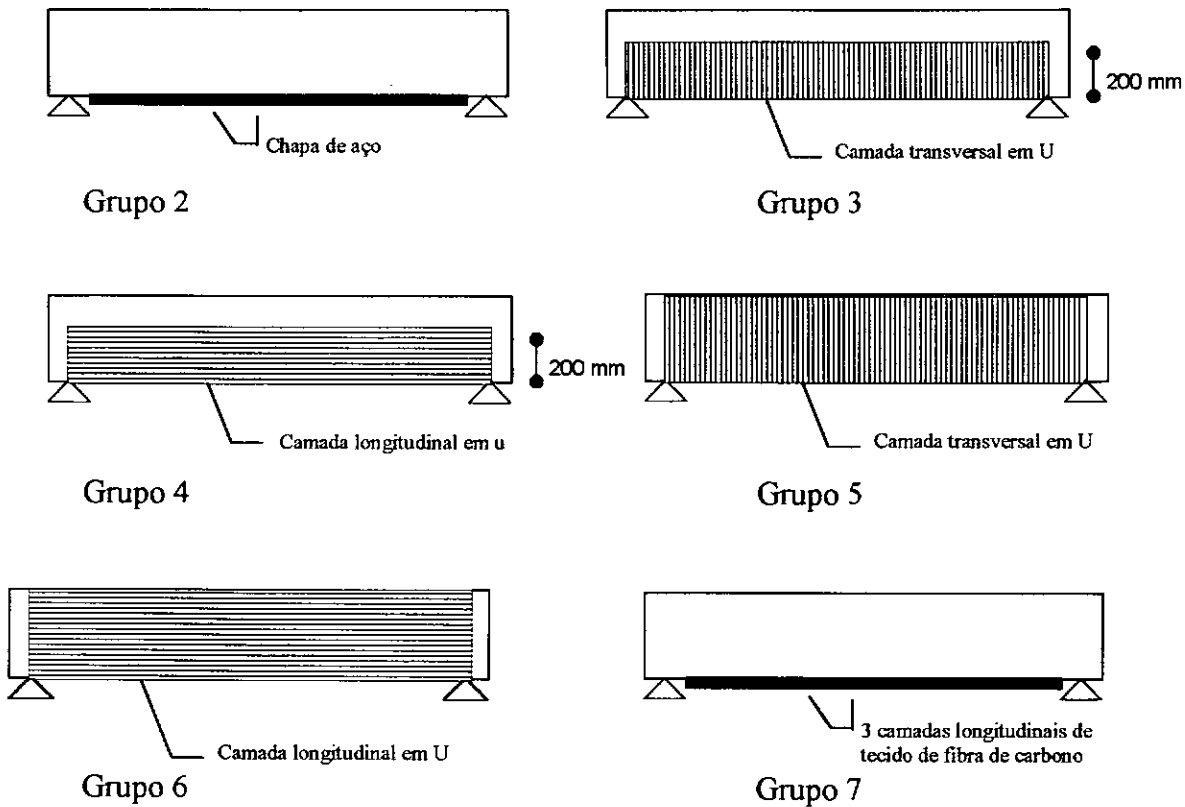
Tipos de reforço usados nas vigas de GANGARAO et al.
